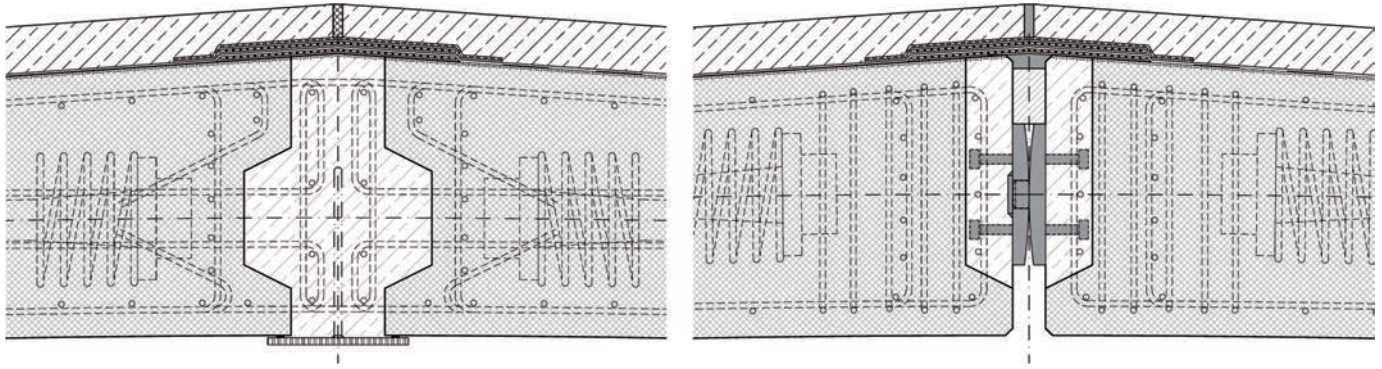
Scheitelgelenk; links Beton, rechts Stahl
